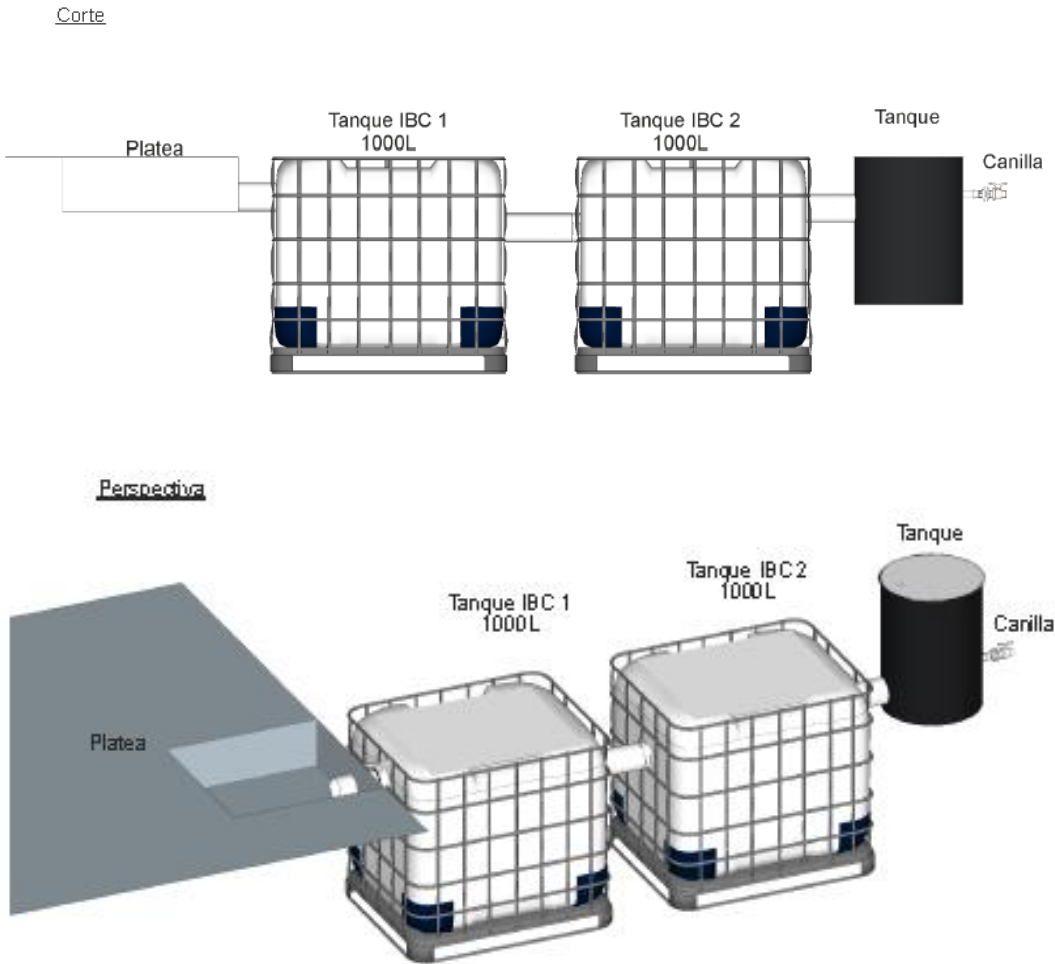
Sistema de tratamiento para obras con poco espacio para instalación de pileta de lavado
